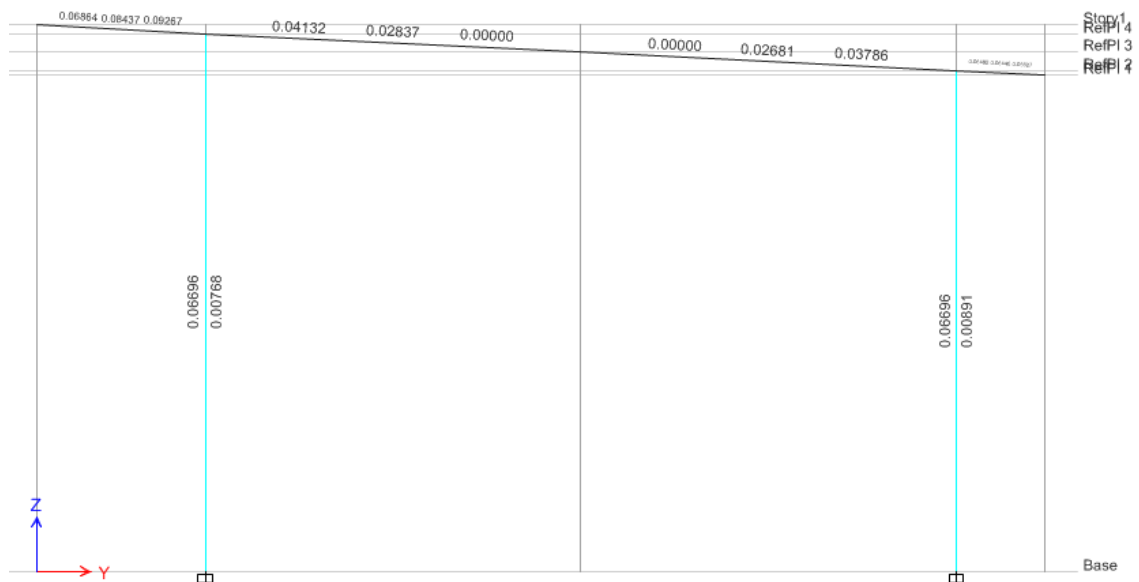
Área de acero por corte de viga (25X60) de Módulo II y V
